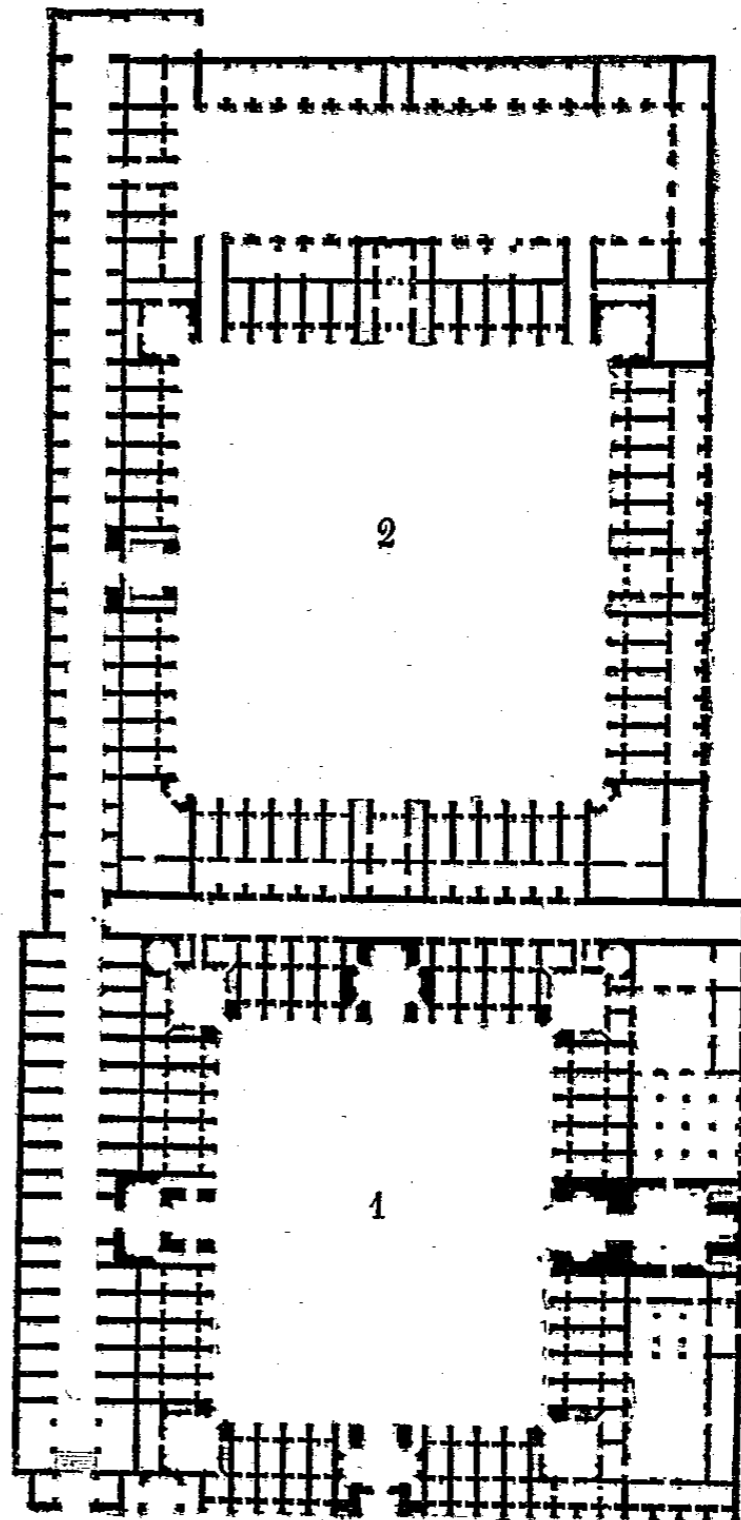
Plan de la Madrasa (1) et du caravansérail (2) Châh Sultan Hosain, à Ispahan.
